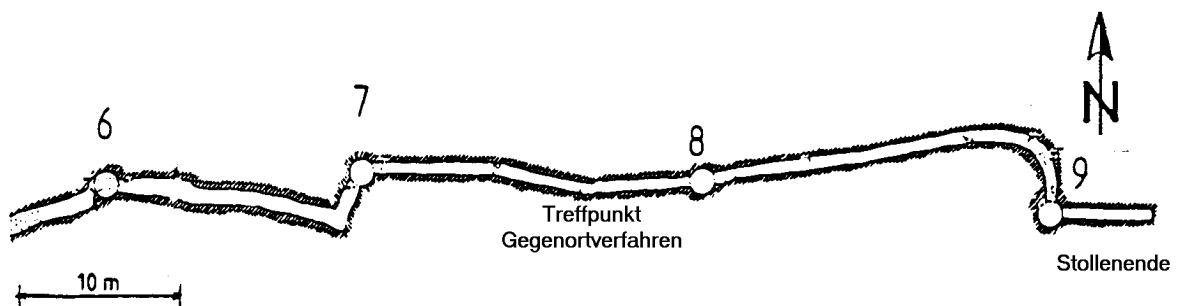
Lageplan 6-7-8-9 mit Fehler bei der Richtungsabsteckung bei Schacht 9 und mit Treffpunkt des Gegenortverfahrens zwischen den Schächten 7 und 8
